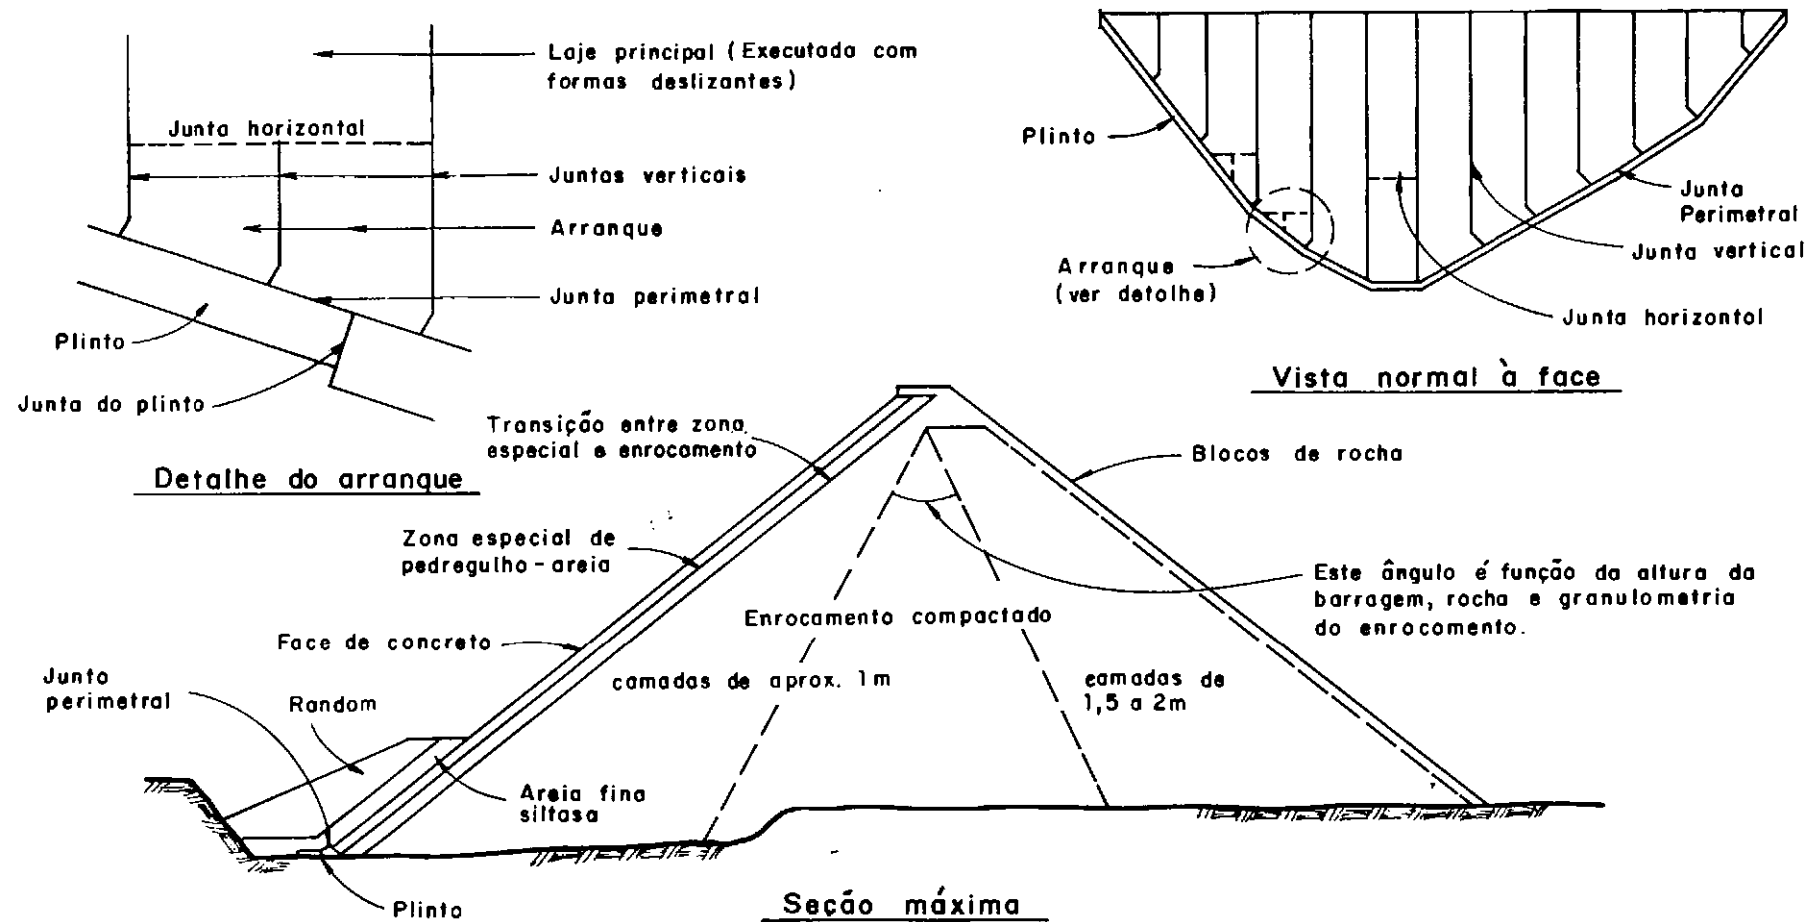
Definições básicas da barragem de enrocamento com face de concreto
